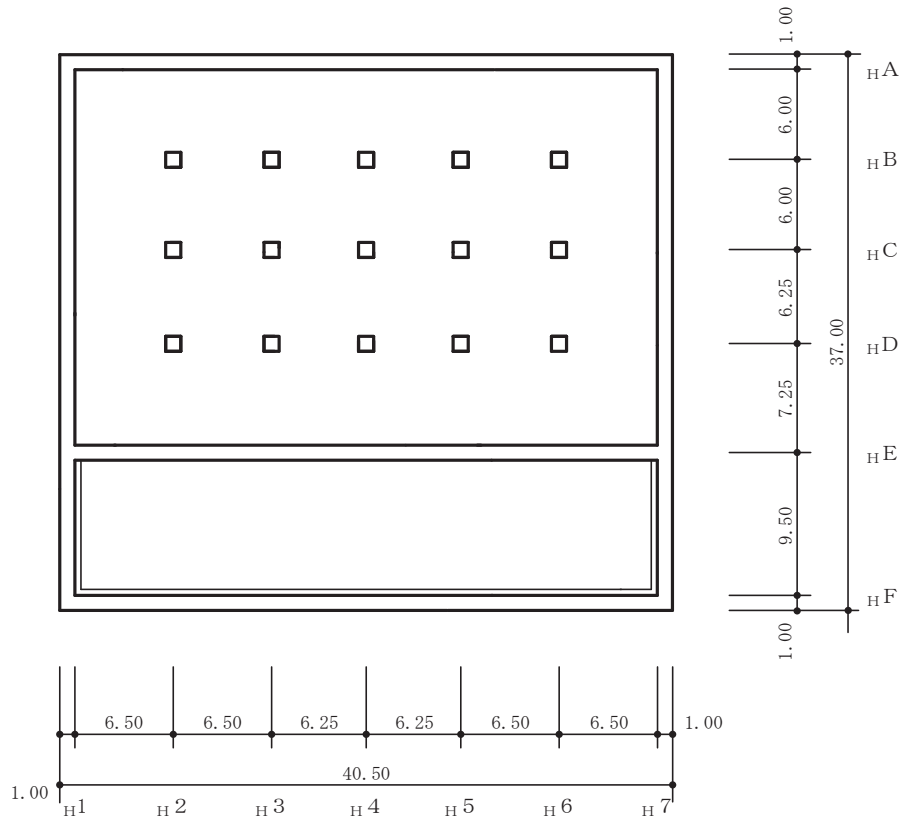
(1) 第 3 号機海水熱交換器建屋の概略平面図 (0.P. -9.5m)
